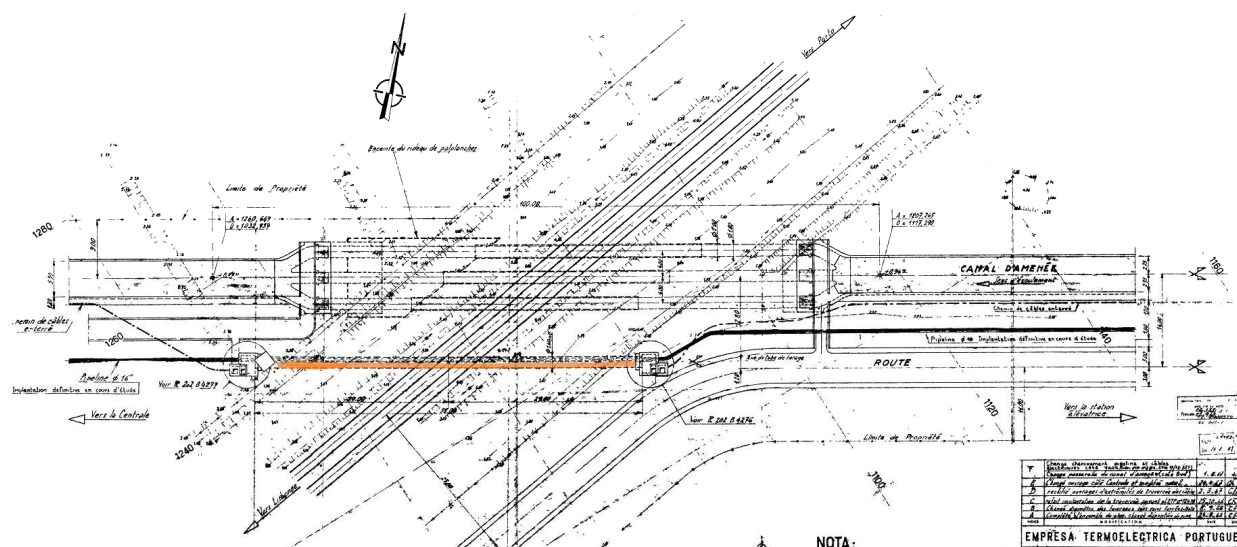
Canal de Adução (PK 37+385) (in imagens 16065)
